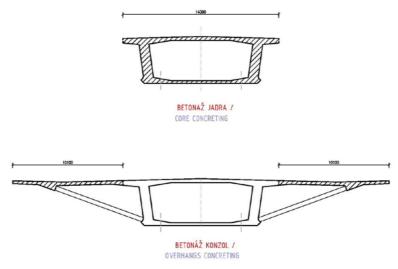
Fases de construcción de la sección tipo del tablero. Arriba se define el cajón central del tablero de 14.3m de ancho, y abajo se definen los voladizos de 10.1m de ancho.
